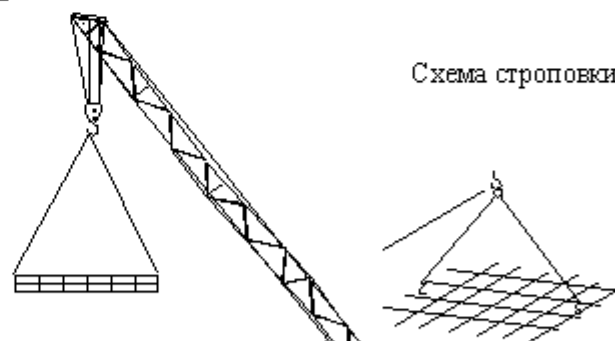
Общая схема монтажа арматурных сеток и каркасов
